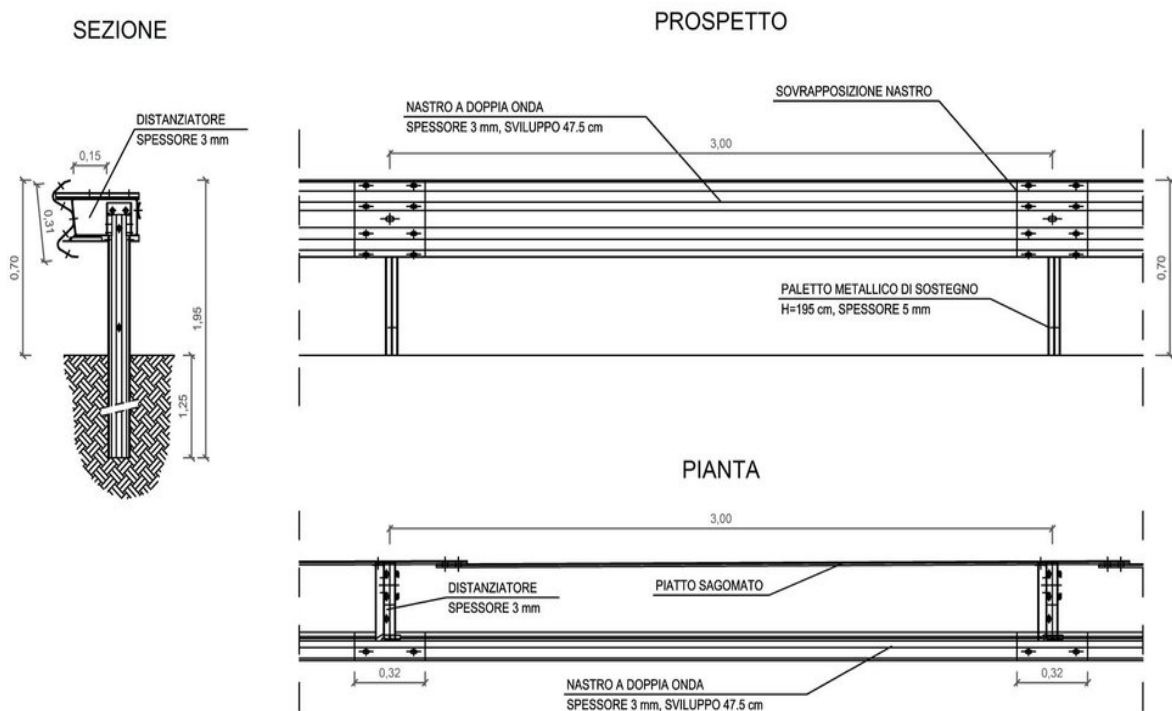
Elementi strutturali barriere metalliche(Archwed.it)
